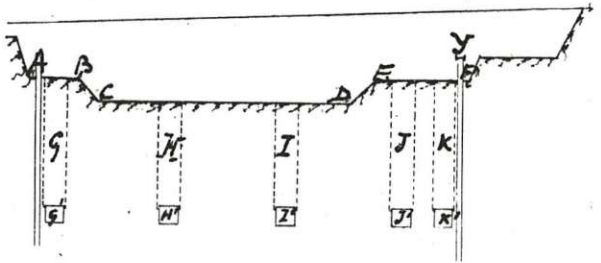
a) Rabattement de la nappe aquifère à partir de A, B, C, D, E, F; b) Mise en place de la poutre (métallique ou en béton armé) Y destinée à solidariser les têtes des palplanches du rideau le plus exposé à cause de la proximité des faux puits J et K, principalement au droit des joints de dilatation où ces faux puits sont doublés; c) Creusement des faux puits G, H, I, J, K à la faveur du rabattement de la nappe aquifère; d) Mise en place des viroles métalliques G', H', I', J', K'.
